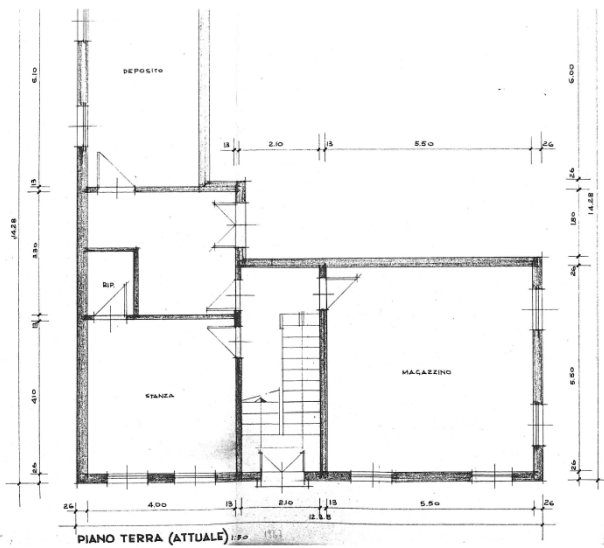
Pianta e prospetto di porzione di fabbricato (1967)
